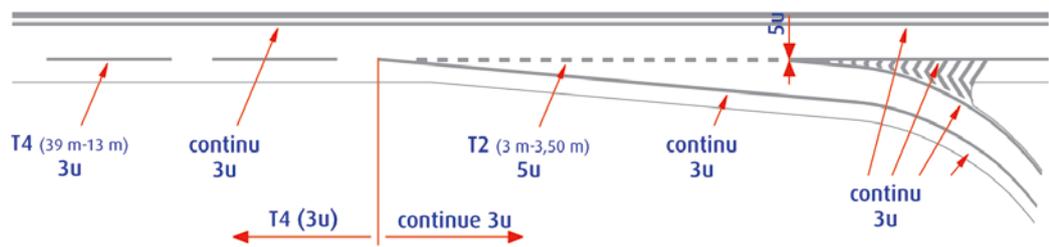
signalisation type au niveau d'une bretelle de sortie en déboitement
